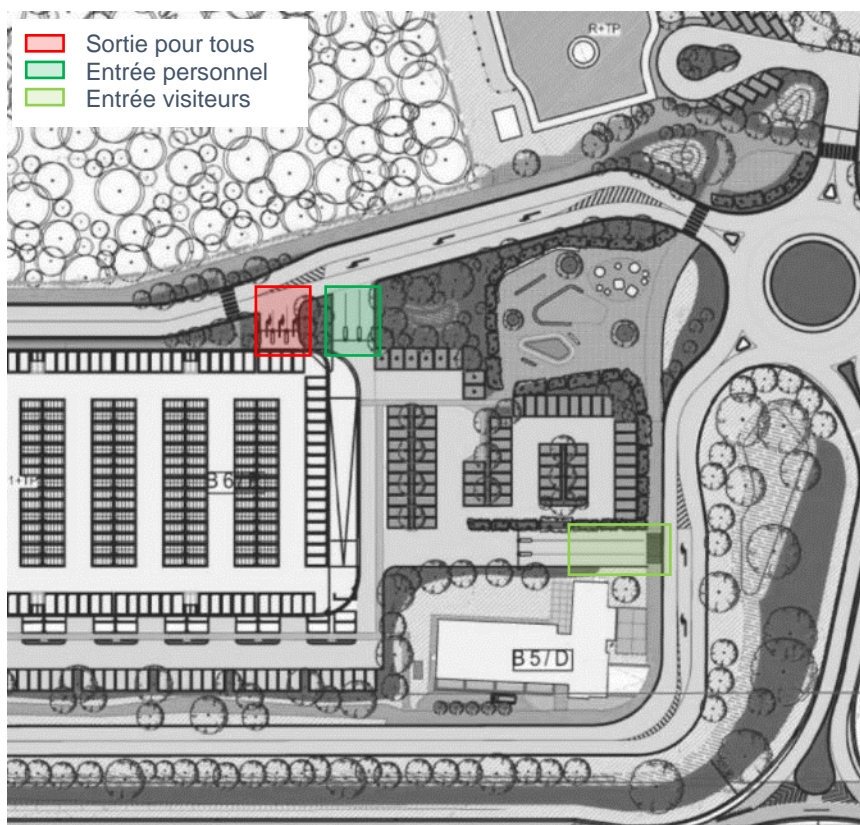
Entrées et sorties du parking au niveau -1 (source : assar architects)
